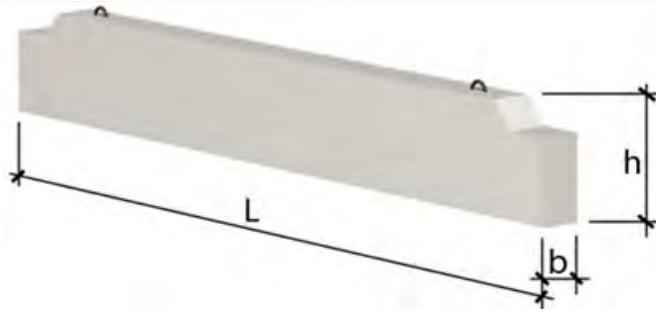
Крупноразмерный железобетонный прогон ПР 60.4.4-4
